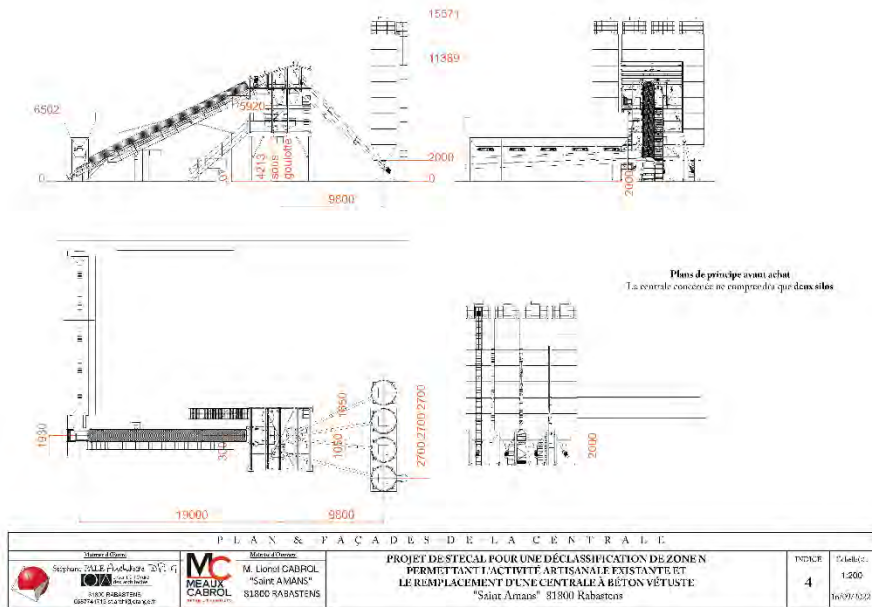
coupes et façades du projet à l'étude, source Stéphane Palé architecte
